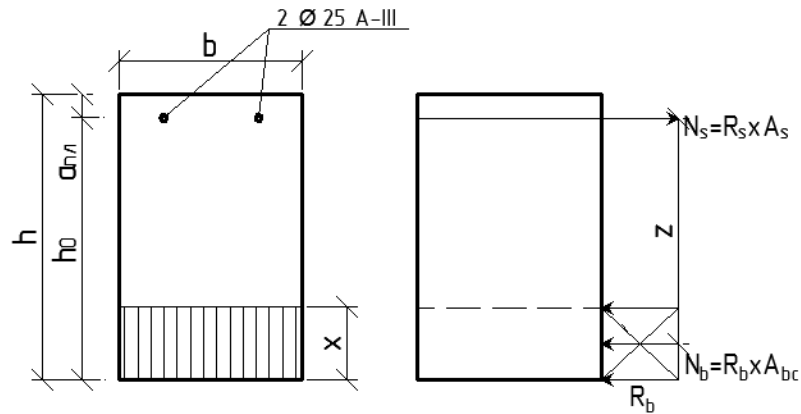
Схема внутренних усилий ригеля на промежуточной опоре
